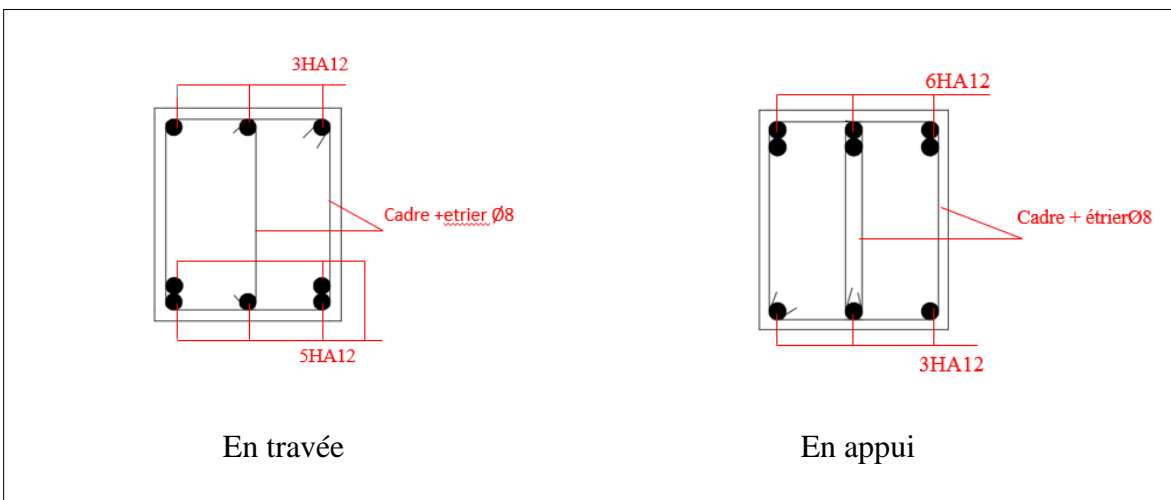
schéma de ferrailage de la poutres secondaires RDC à 3^{eme} étages.
